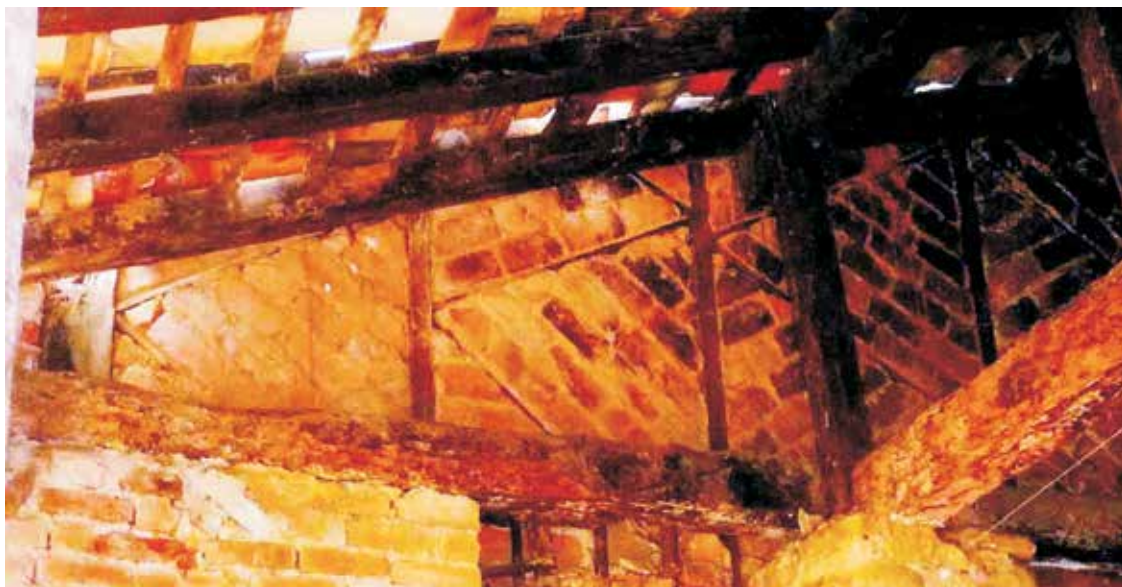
Alvenaria de tijolo. Paraty, século XVIII.
